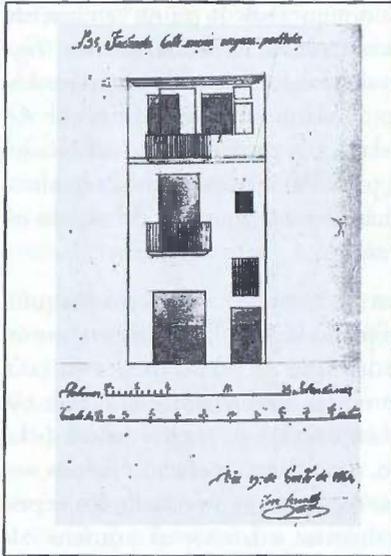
Plano de proyecto de reforma de la fachada redactado por el arquitecto José Serra en 1864 (AHMV, 1864).
